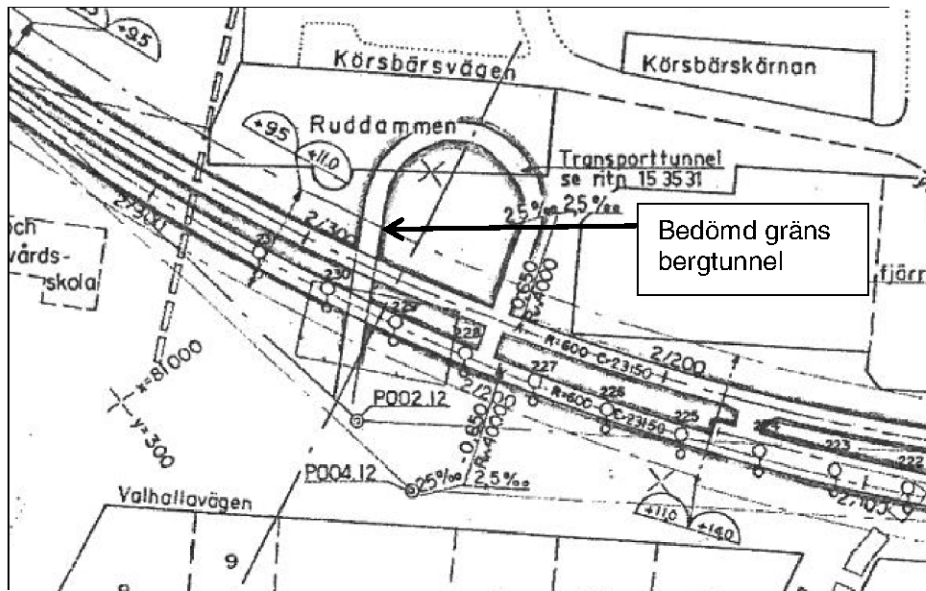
Anslutningstunnel till tunnelbanan med angiven gräns mellan bergtunnel och cut-and-cover
